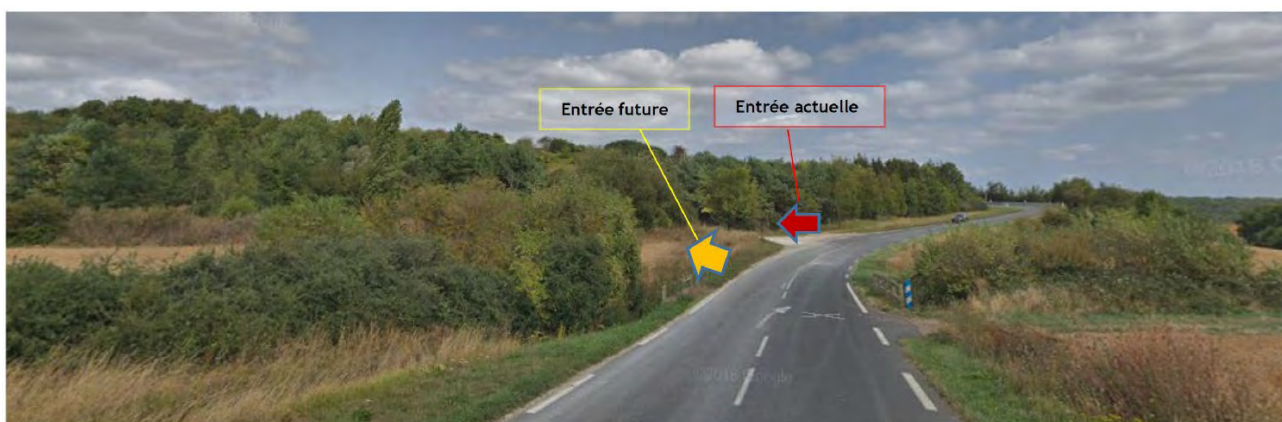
Vue du future accès au site par la RD 63 par l'Ouest.
